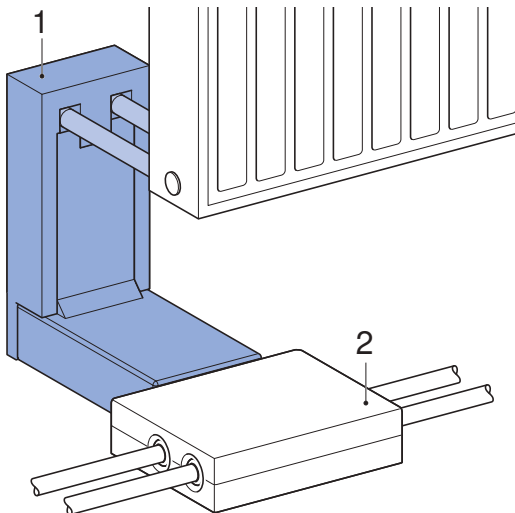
Caja de conexión de radiador tipo C para construcciones de soldado elevadas
